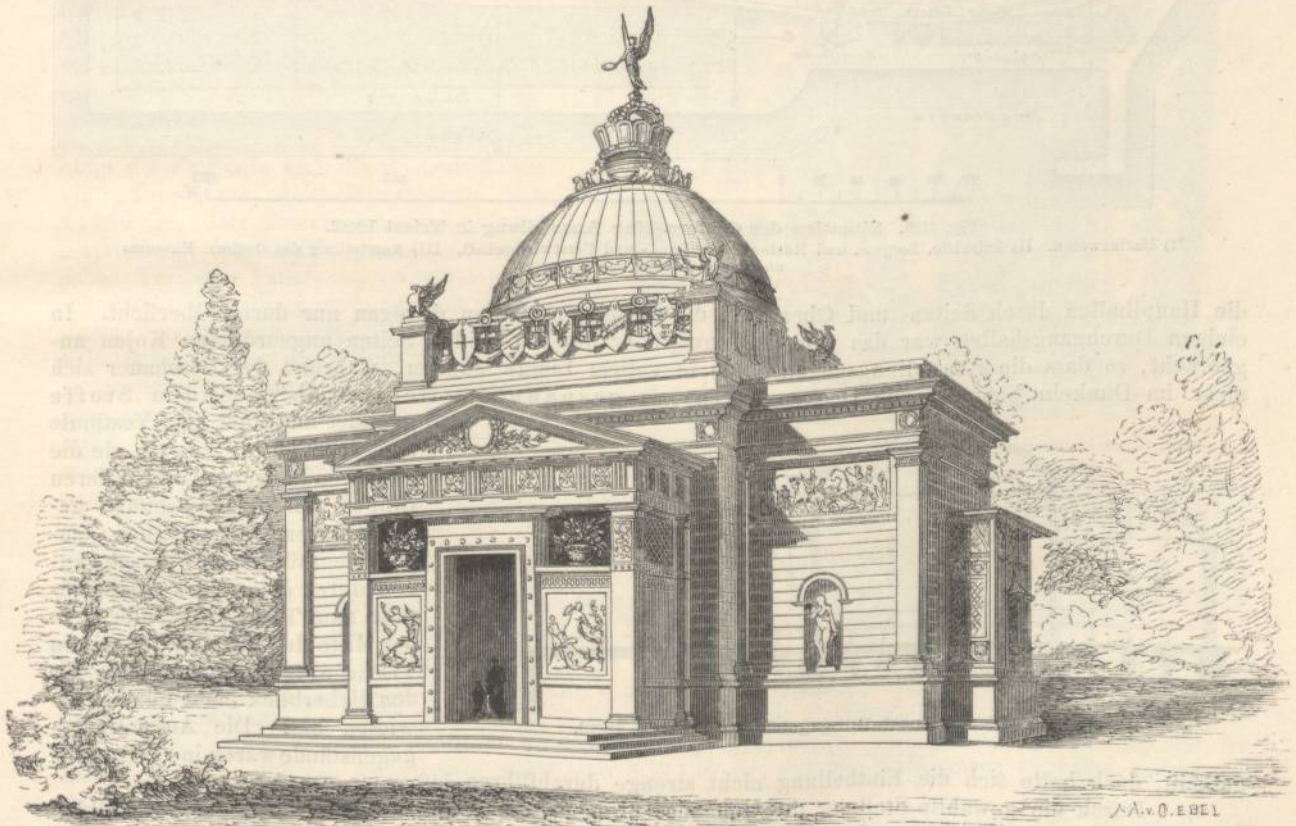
Fürsten-Pavillon der Ausstellung in Frankfurt a. M. (Architekt Paul Wallot).
